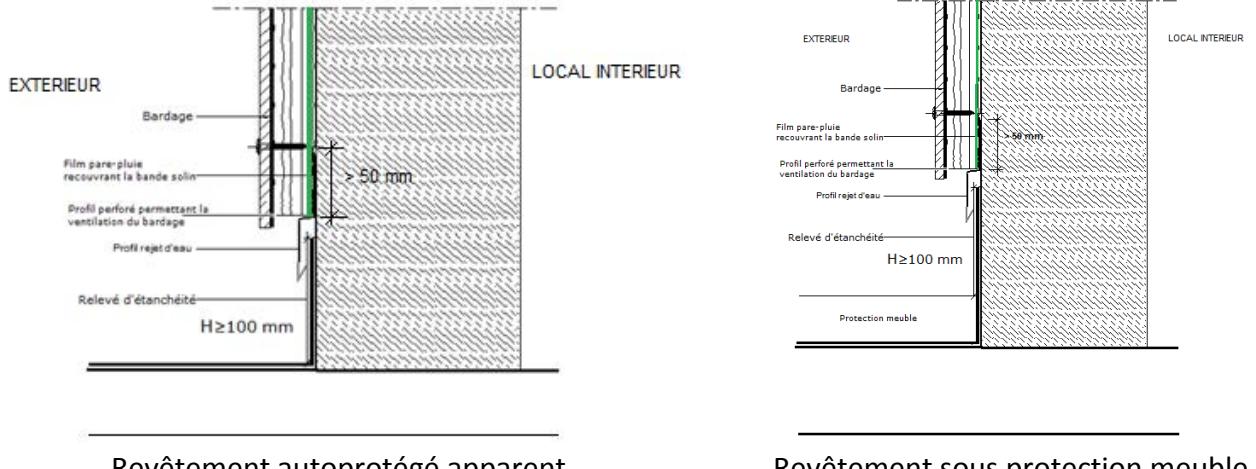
Pied de bardage non isolé (toiture inaccessible et technique)
